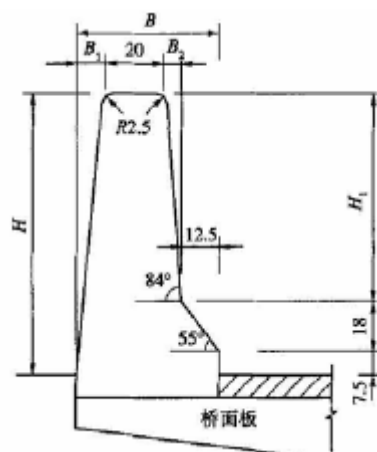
F 型混凝土护栏（尺寸单位：cm）
